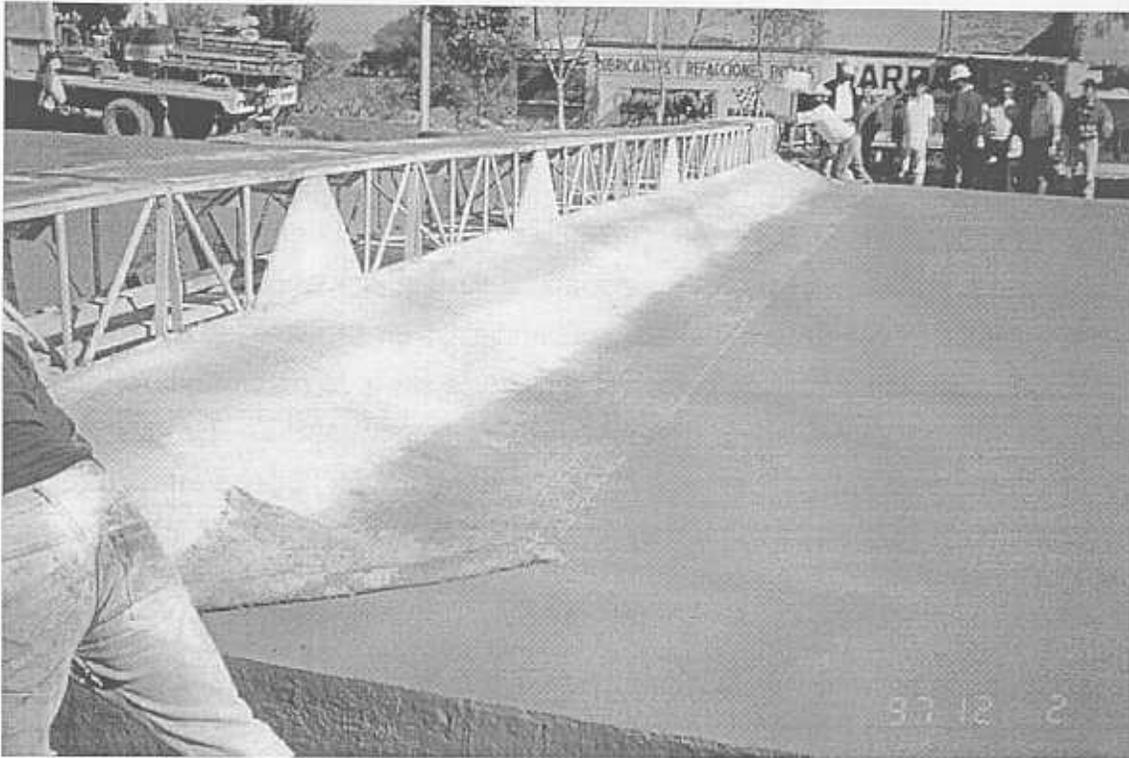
Aplicación de tela de yute para la microtextura en un pavimento de concreto hidráulico.
